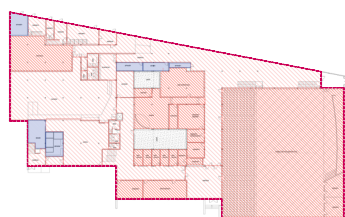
Clasificación de recintos. Planta baja pabellón E.
